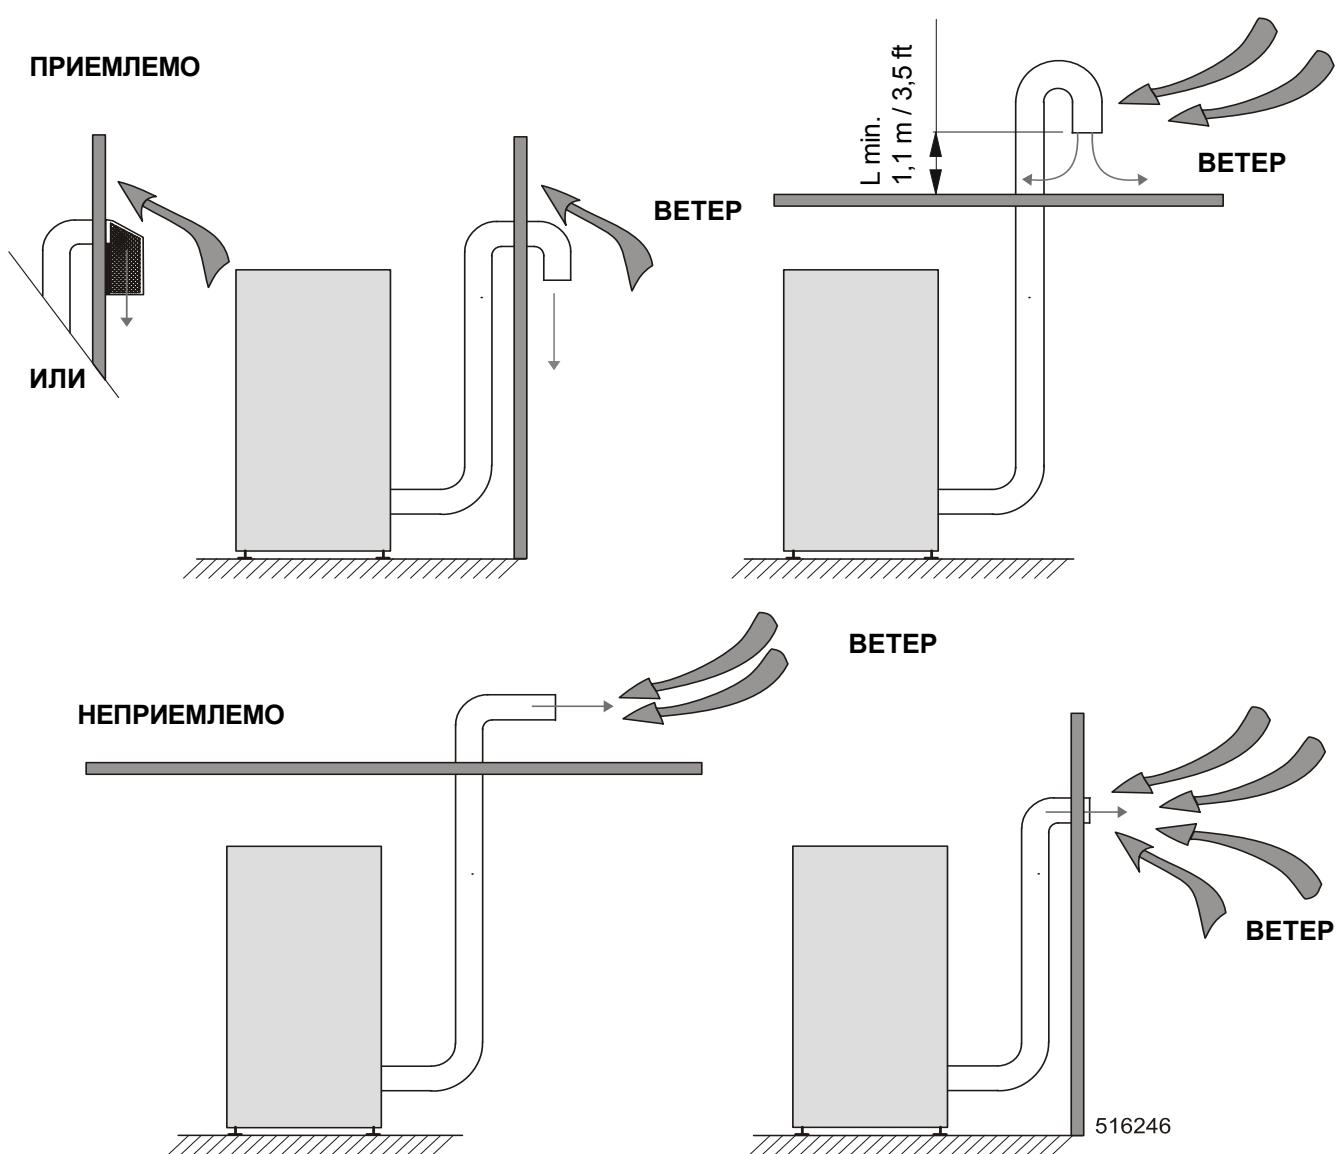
В. Отдельный вентиляционный трубопровод
